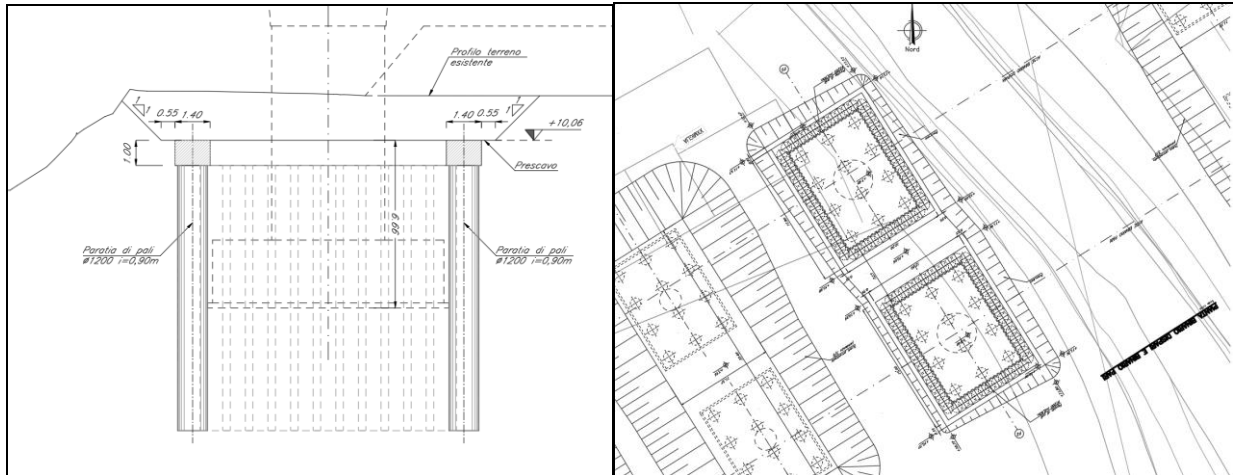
sezione trasversale e pianta dell'opera di presidio per lo scavo delle fondazioni del viadotto VI02
